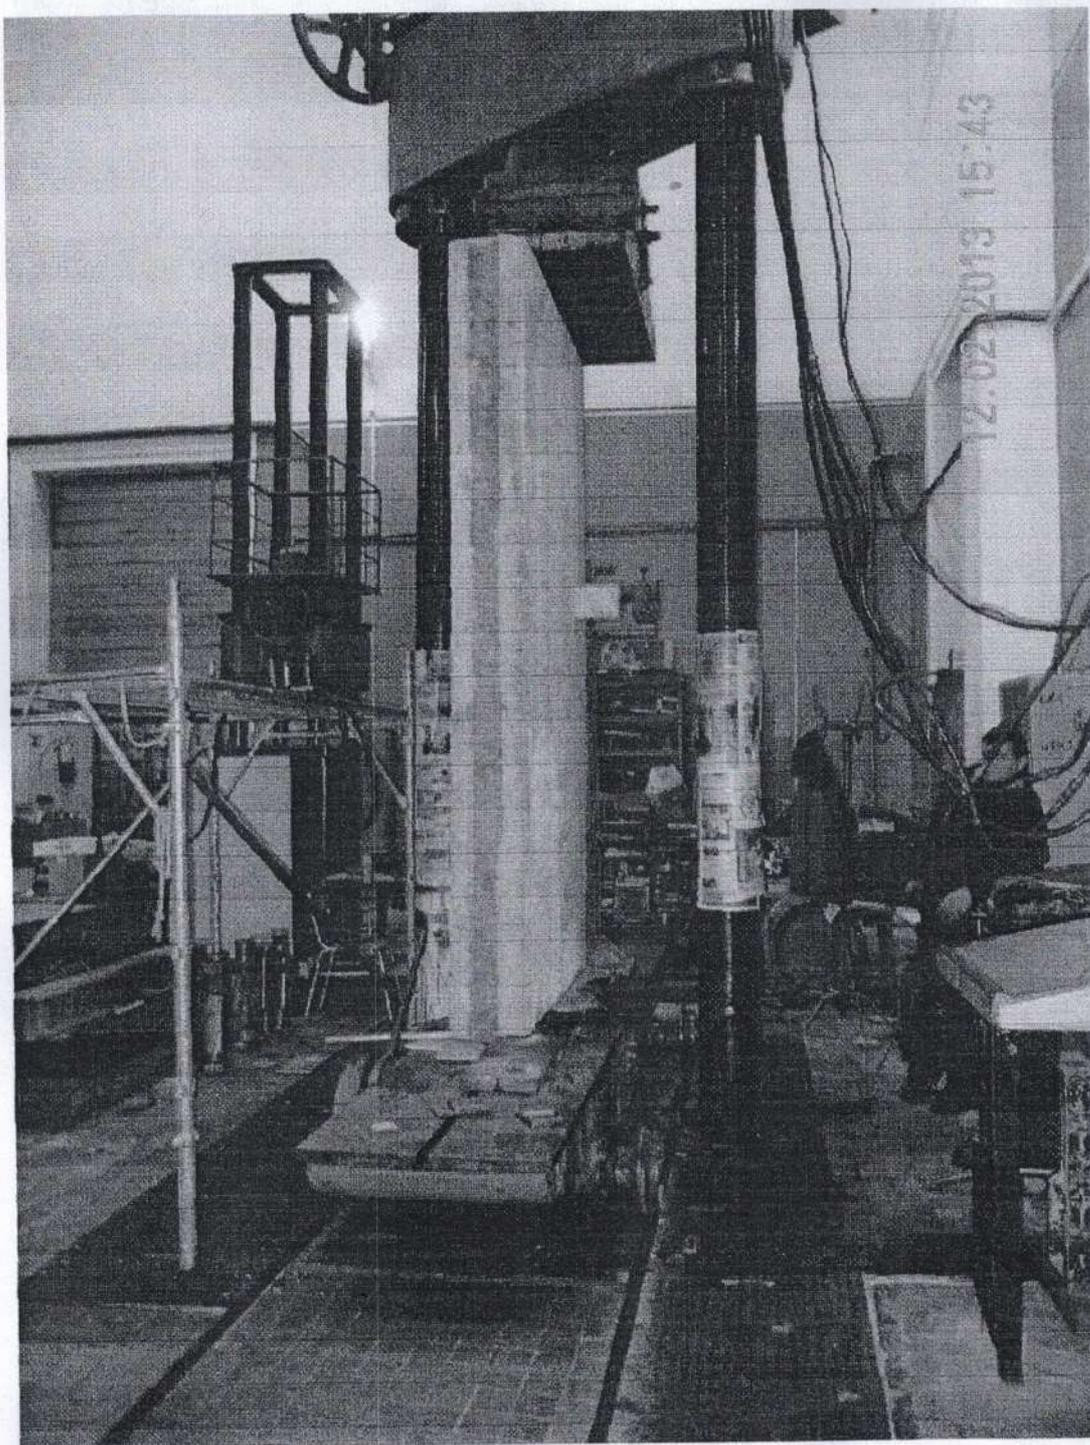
Общий вид опытного образца, установленного в пресс.
